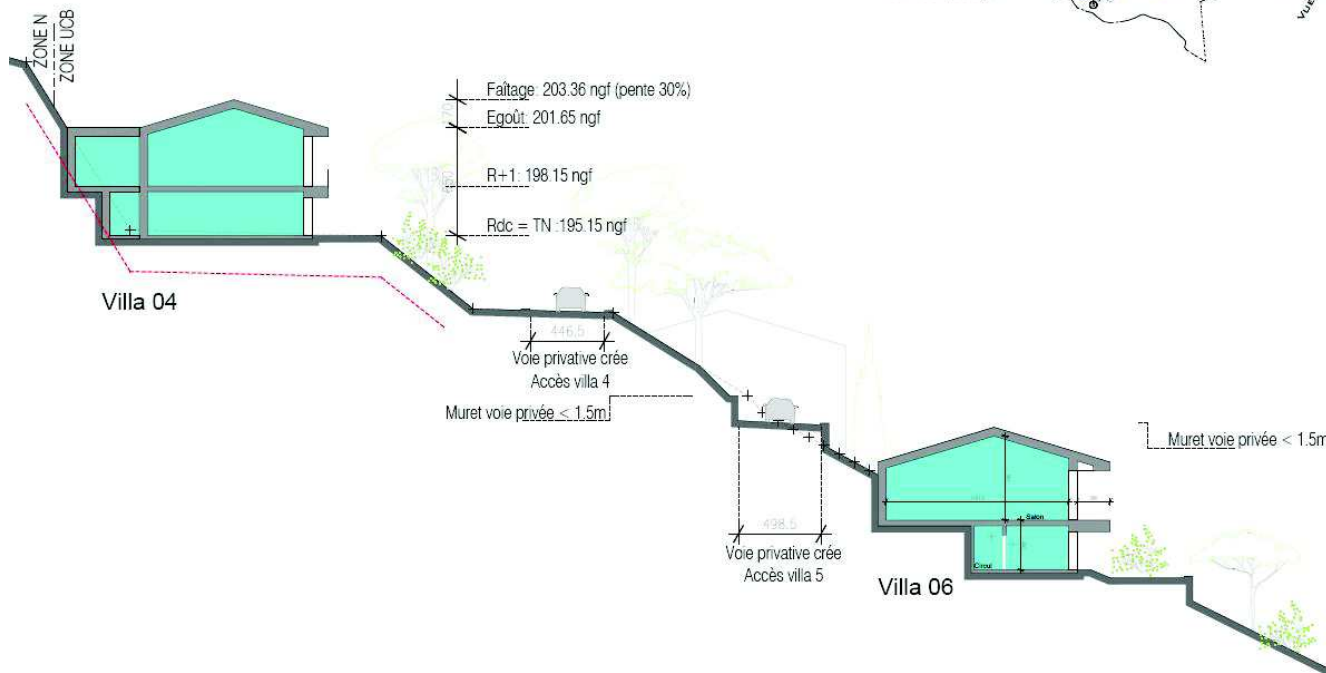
Plan masse du projet (extrait de plan Architecte)
